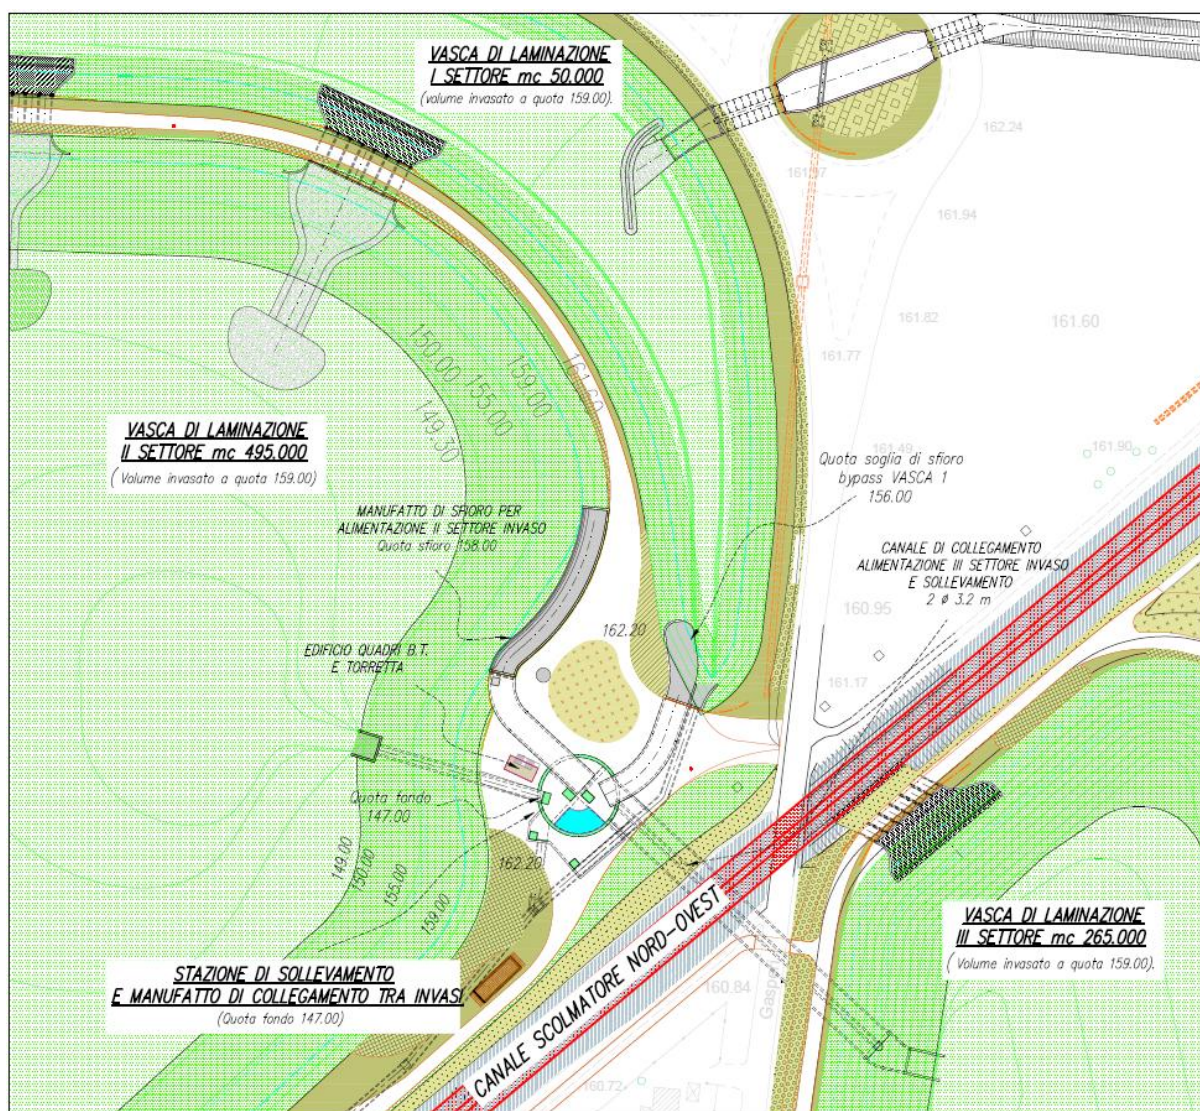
Stralcio planimetrico con rappresentato il sistema di collegamento tra il II al III settore dell'invaso
